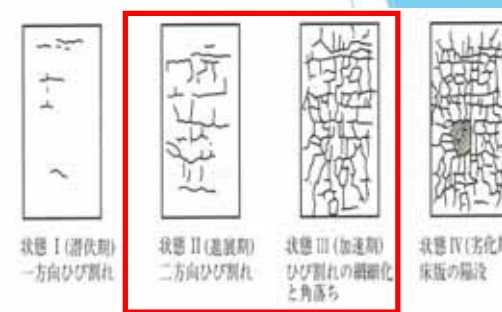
鉄筋コンクリート床版の下面のひび割れと劣化状態
